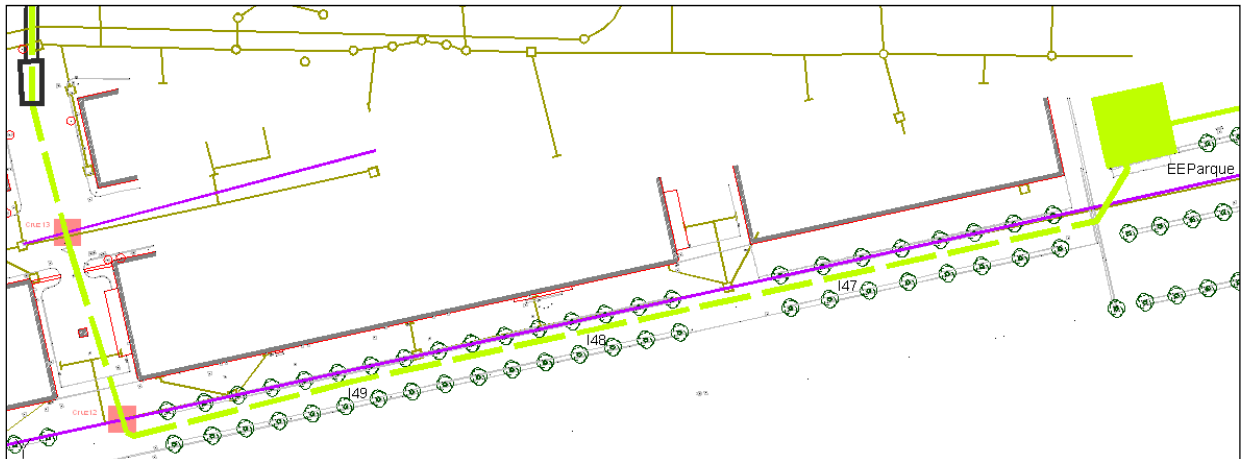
Representação esquemática do traçado proposto para a conduta elevatória da EE do Parque até ao poço de arranque da perfuração horizontal.
